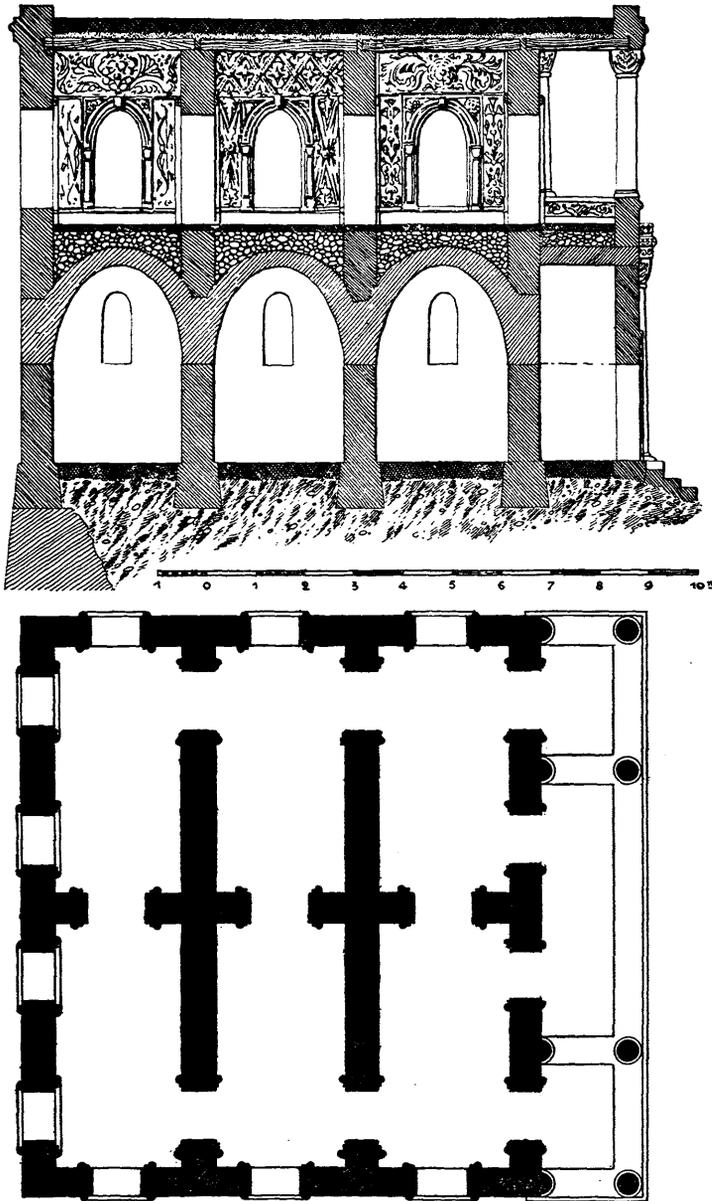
Plan et coupe d'une maison sassanide reconstituée.
